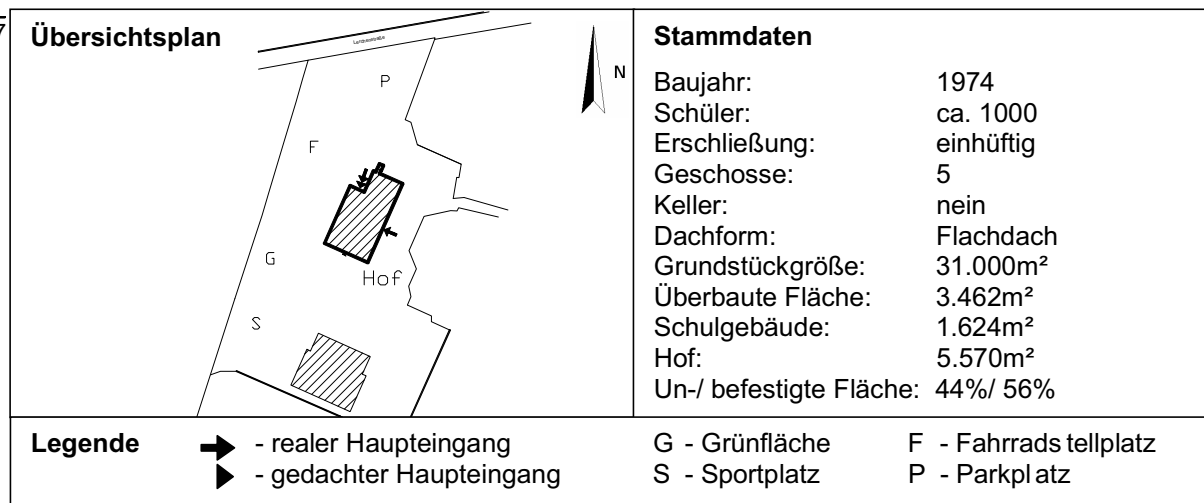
Übersichtsplan und Stammdaten Schulzentrum Lerchenstraße Bremen
